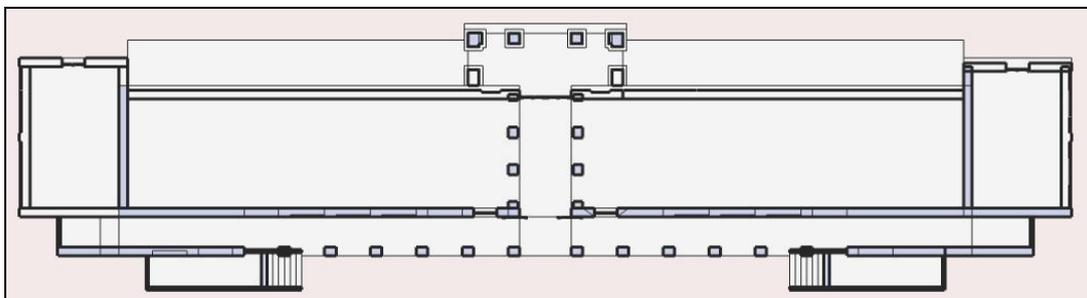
Rencana tapak restoran 'Hallo Surabaya'
